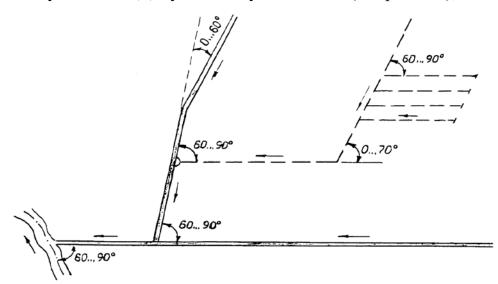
Плановое сопряжение элементов осущительной сети
